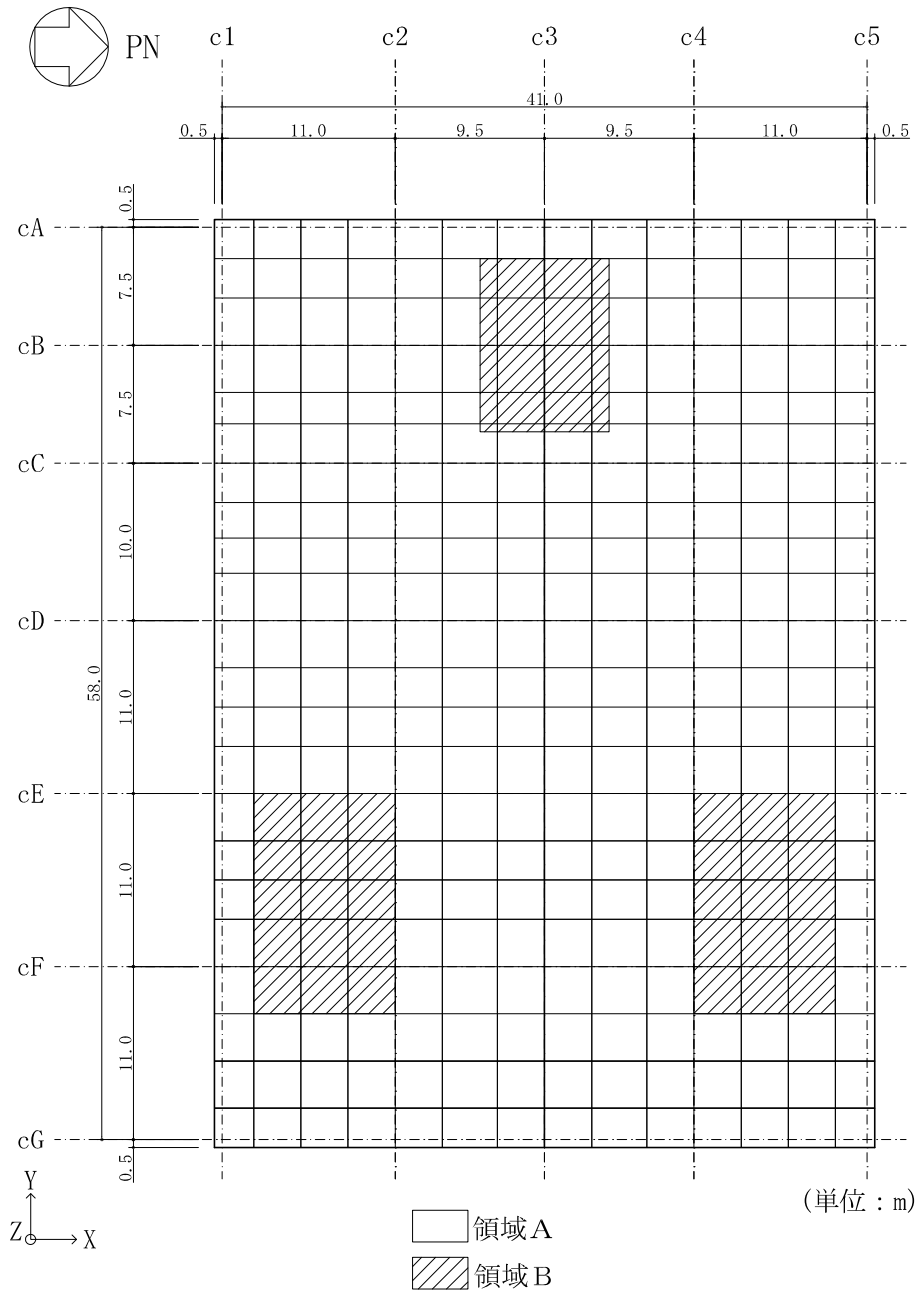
基礎スラブの配筋領域図 (EW 方向, 上ば筋)
